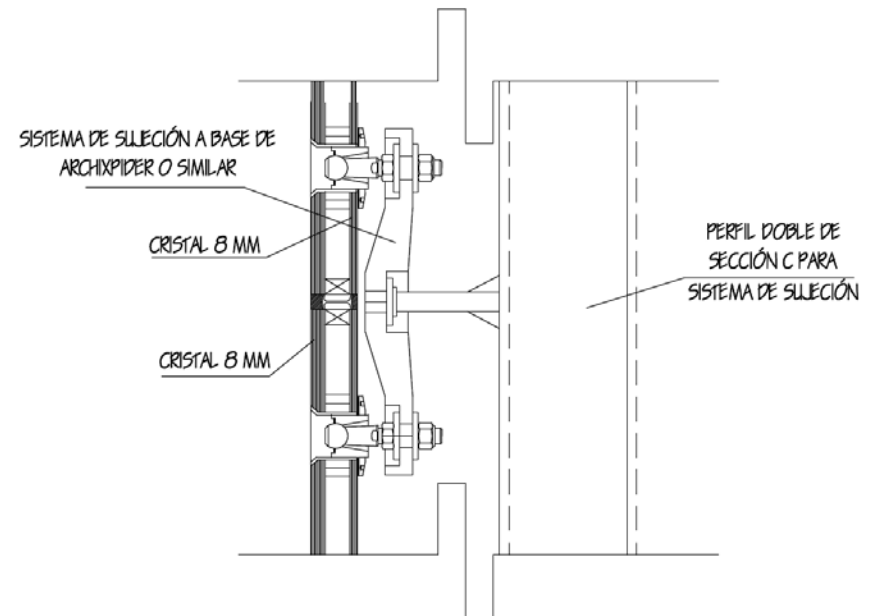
Detalle en planta de colocación del sistema Archipider marca *KINETIC
